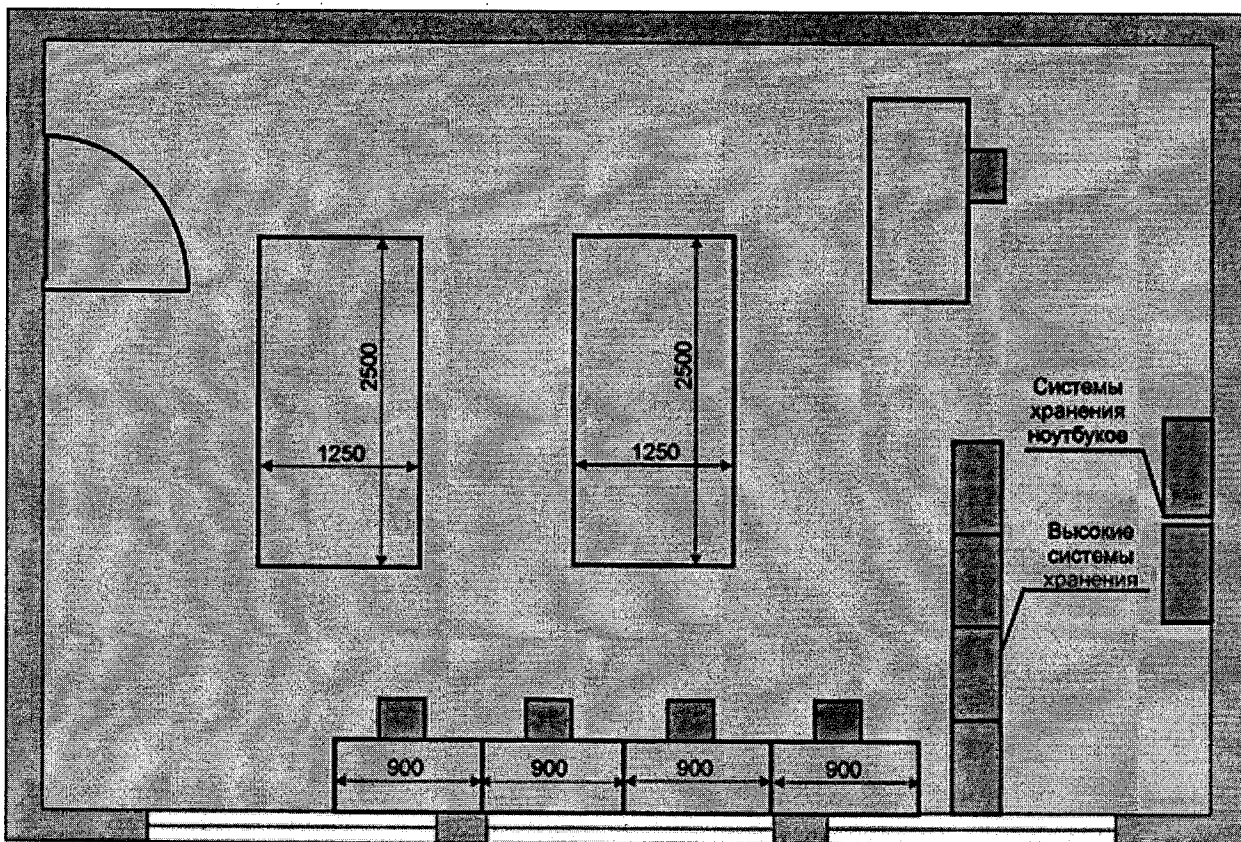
План размещения оборудования в помещении «Аэроквантум»
